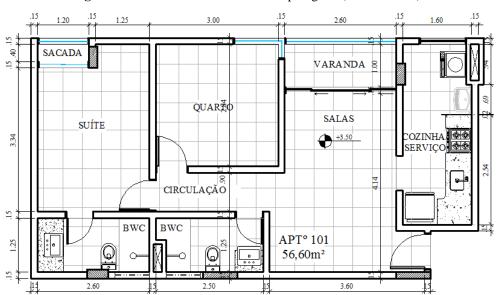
Planta Baixa de UHCde Tipologia 1 (1º Pavimento)
